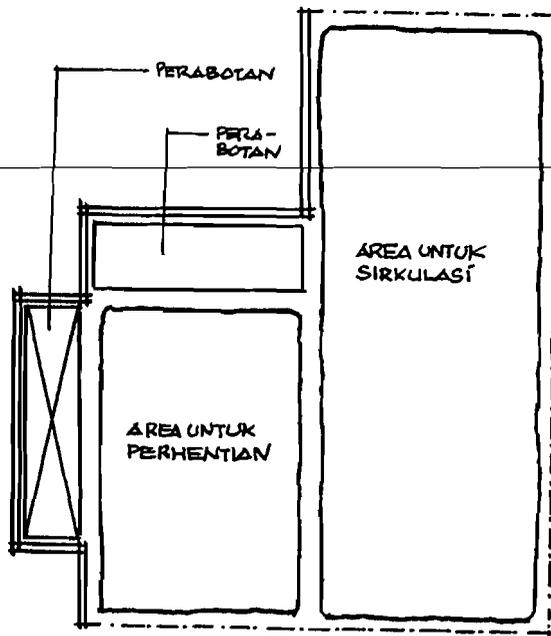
f.: Rencana lay-out ruang pemasaran barang kerajinan keramik.
